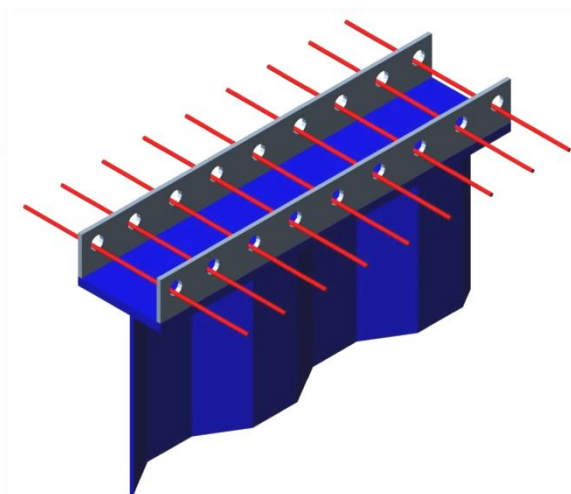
Verbundfuge mit Stahloberggurt und zweireihig Betondübel
